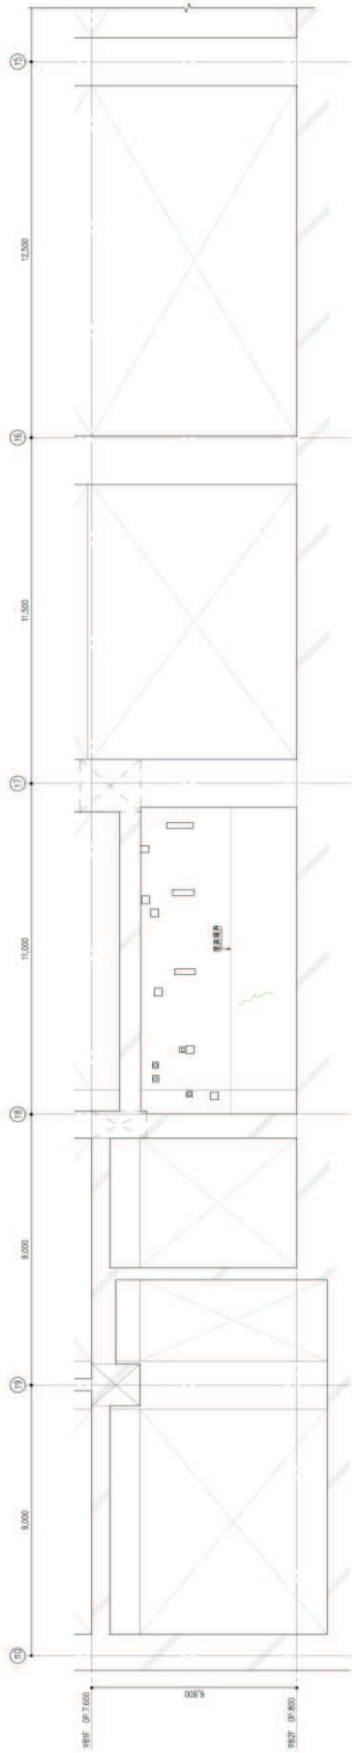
タービン建屋のひび割れ分布 耐震壁 (13) 地下 2 階 TD 通り
